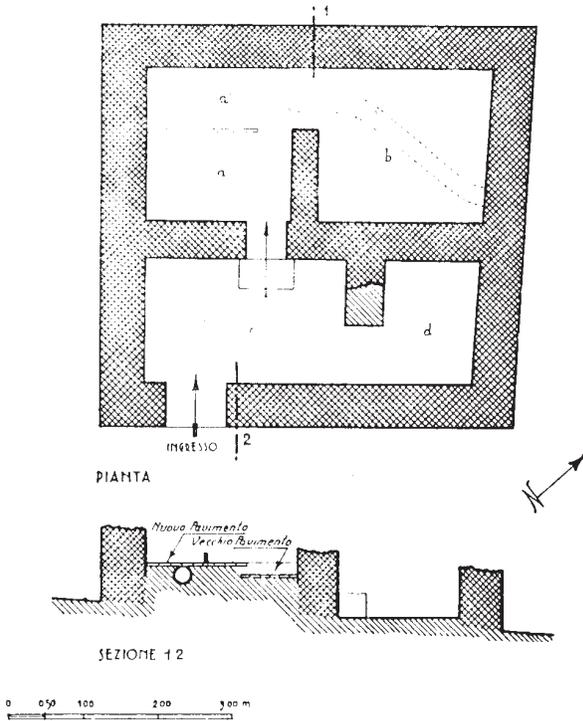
Barumjni, bc. Marfudi: pianta e sezione di casa romana.
